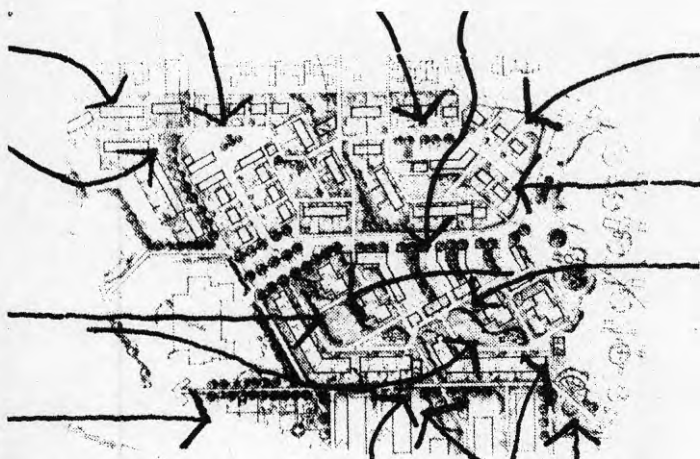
K-konsults förslag, situationsplan. Detalj från (det ej färglagda) originalet.
